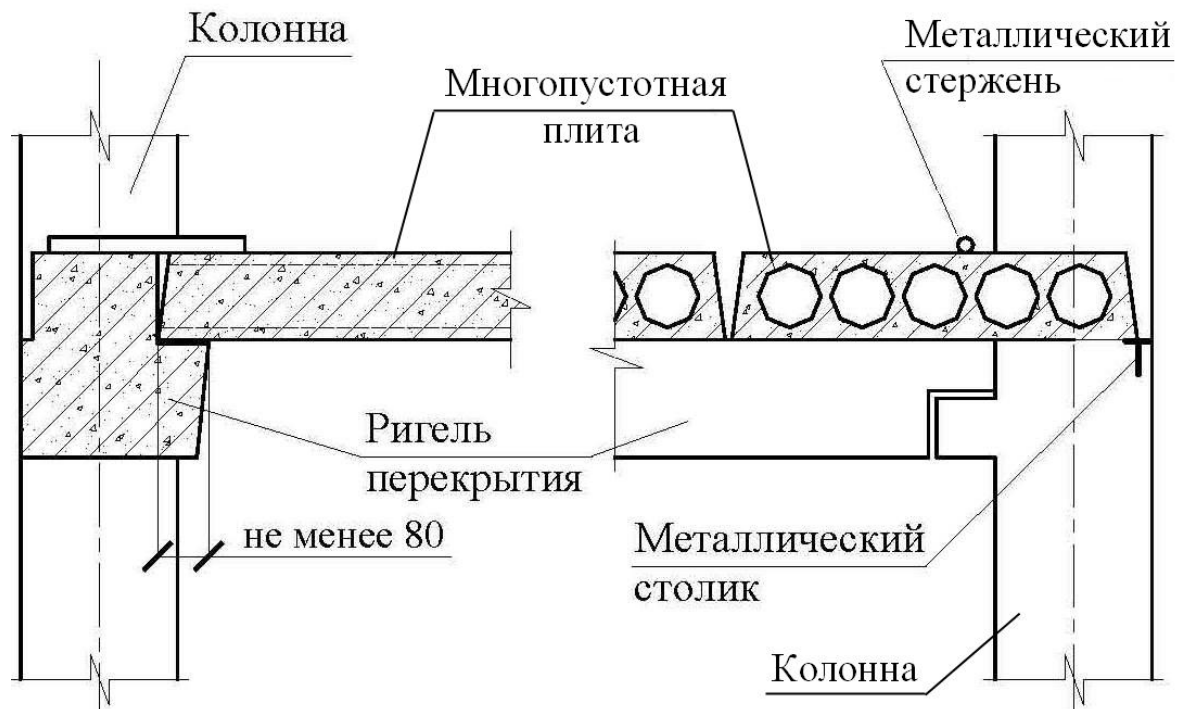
Схема опирания многопустотных плит на ригель по крайней продольной оси
